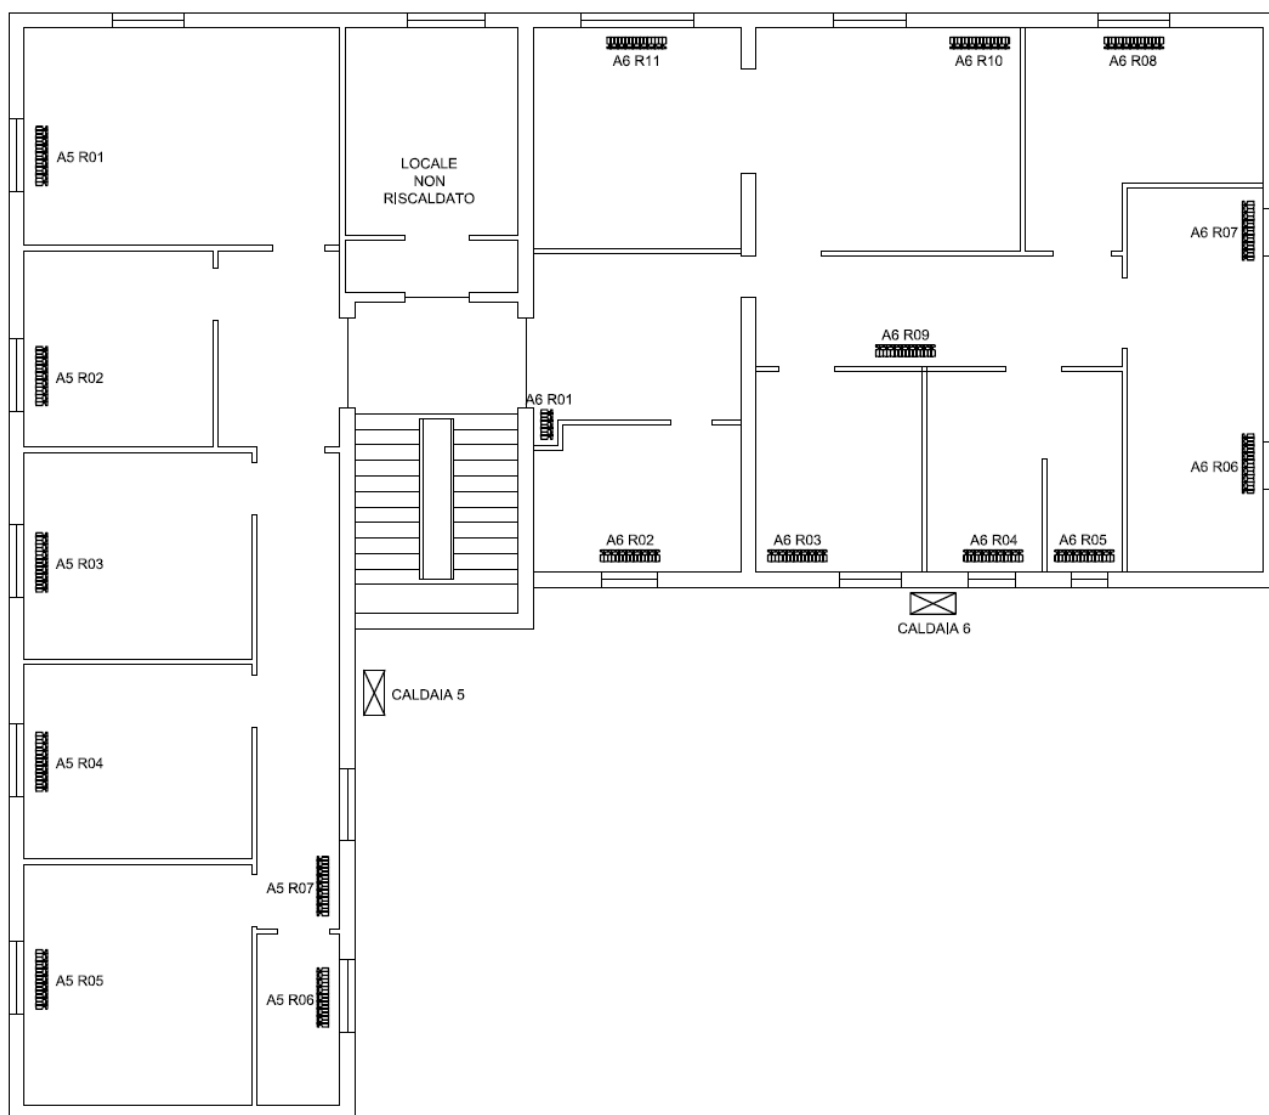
Planimetria Piano terzo (AP_5 e AP_6)
